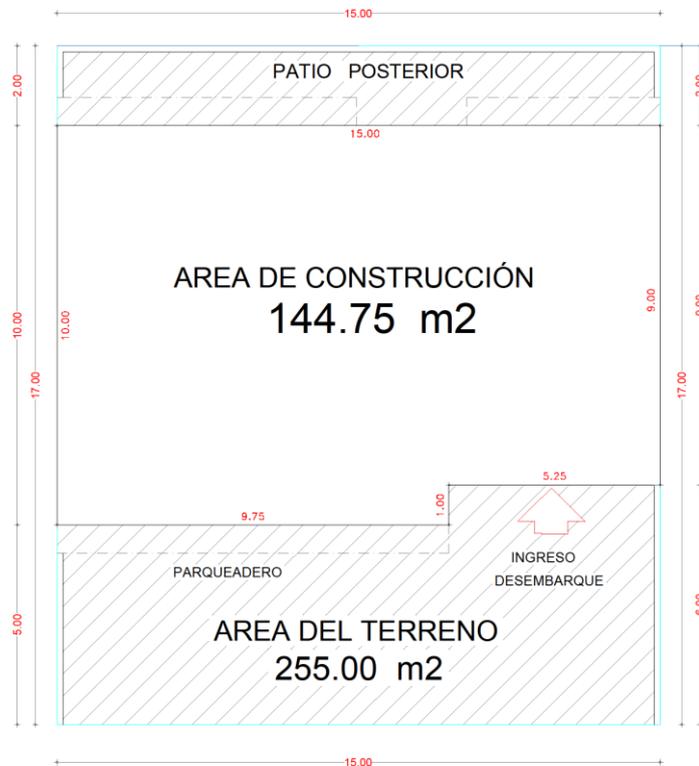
5: Dimensiones Plano arquitectónico de la planta.
